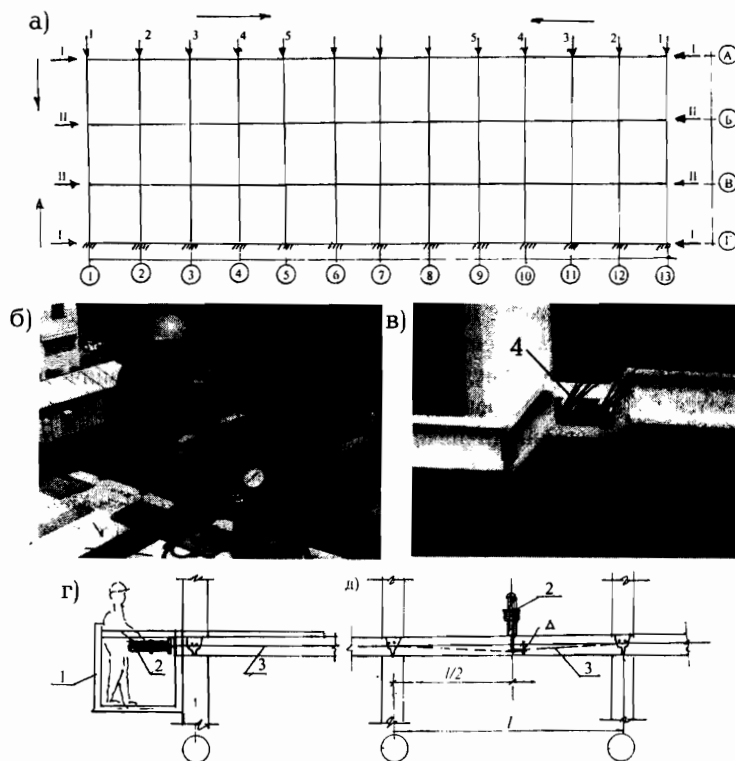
Технология натяжения продольной и поперечной арматуры; а – технологическая последовательность натяжения продольной и поперечной арматуры; б, в – рабочие моменты; г – схема размещения люльки и гидравлического домкрата; д – схема дополнительного натяжения арматуры путем ее опускания; 1 – навесная люлька; 2 – гидродомкрат; 3 – напрягаемая арматура; 4 – гильза
